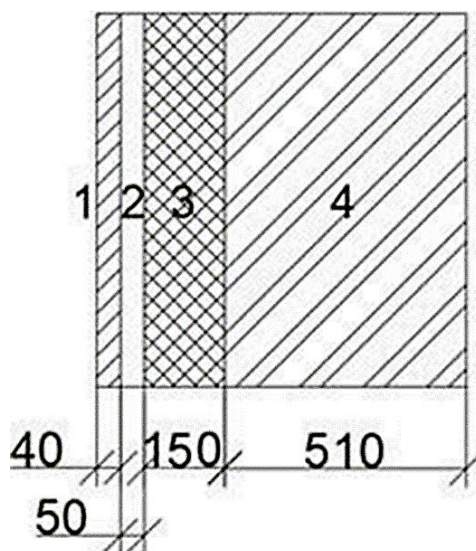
Цегляна стіна з утепленням із мінеральної вати по системі вентфасаду
